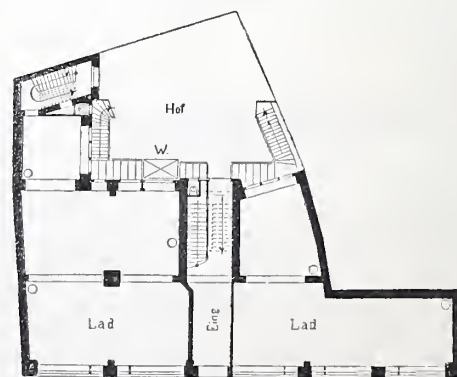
Grundriss vom Erdgeschoss 1:500.
